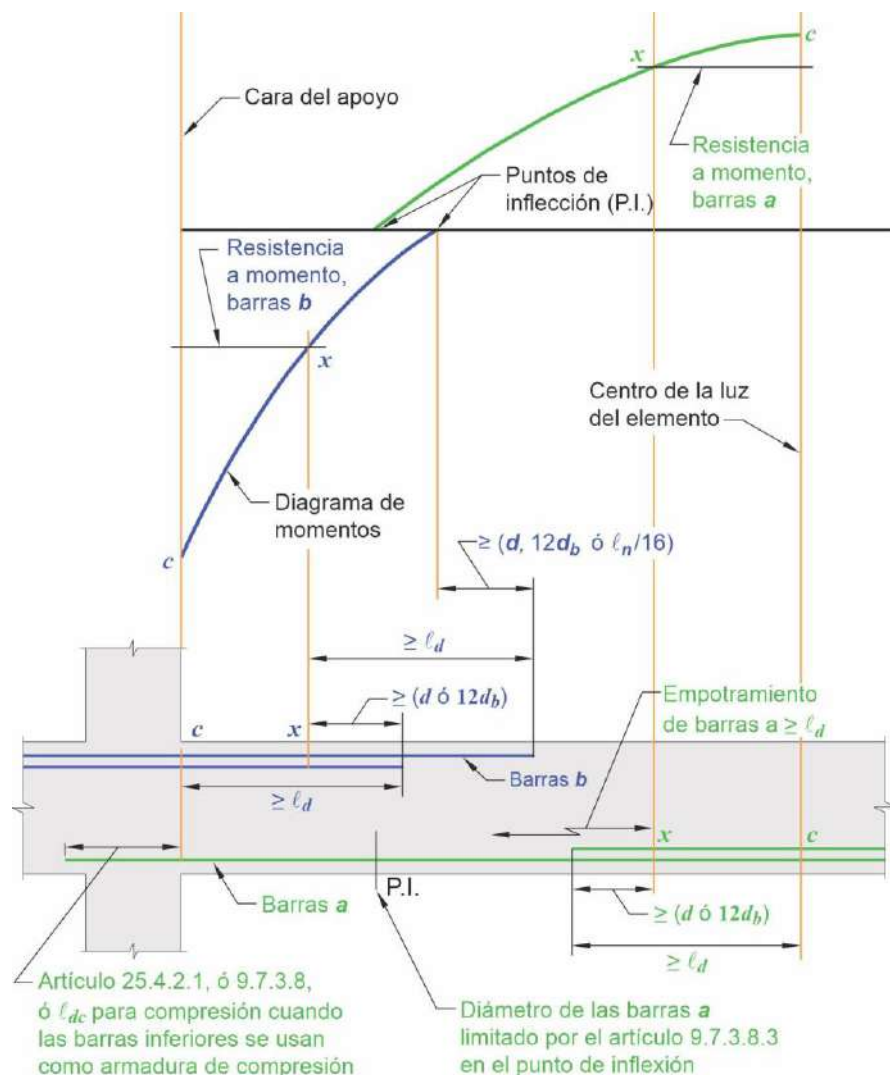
Longitud de anclaje de la armadura por flexión en una viga continua típica.
